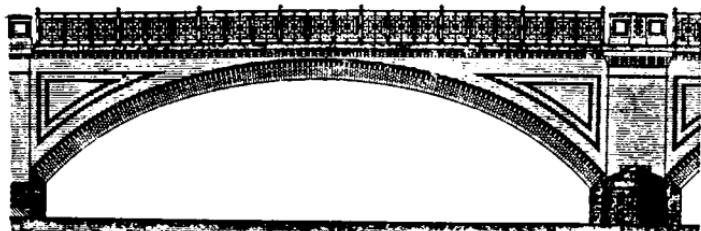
Фасадъ моста близъ Берлина, съ кирпичной облицовкой.
